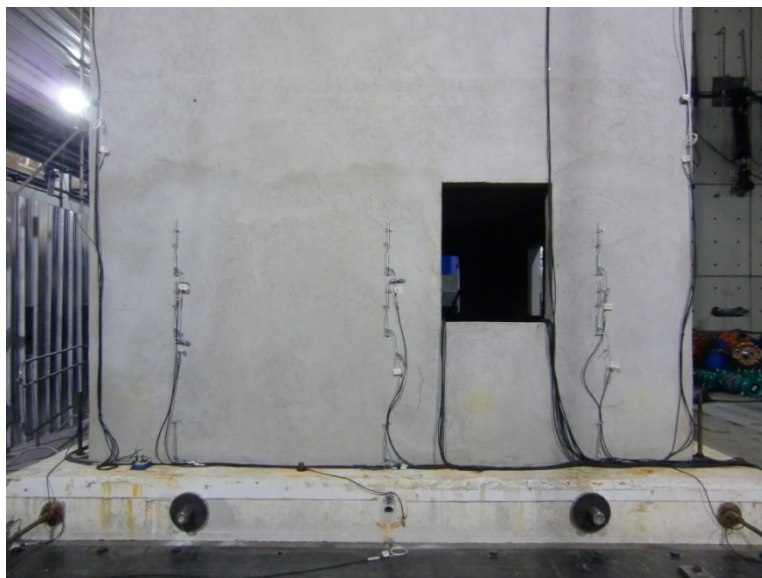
Foto delle pareti dopo il test a 1.2g: esterno piano primo.
